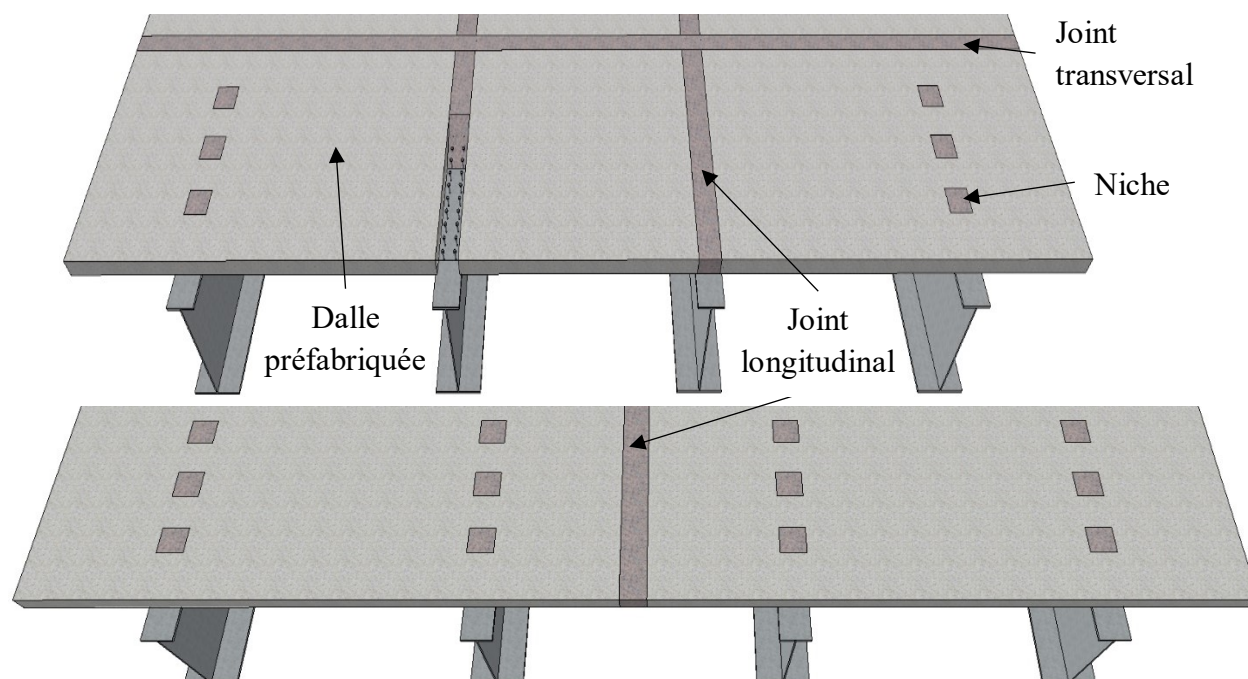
Pont à dalles préfabriquées sur poutres avec joint de connexion
